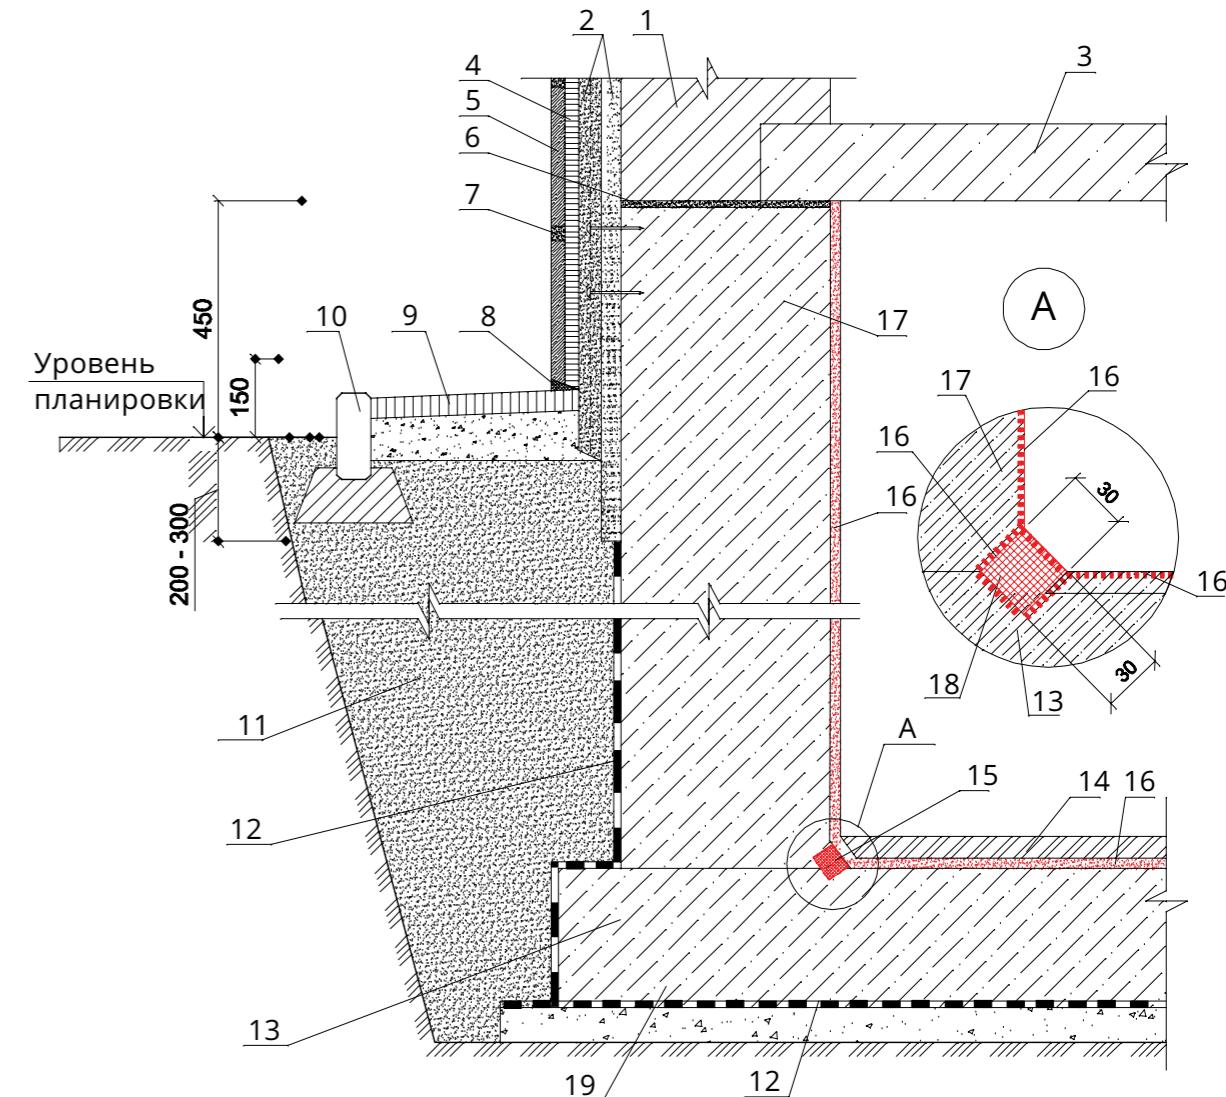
Узел 1. Гидроизоляция стены и фундаментной плиты с внутренней стороны подвала (ремонт)
